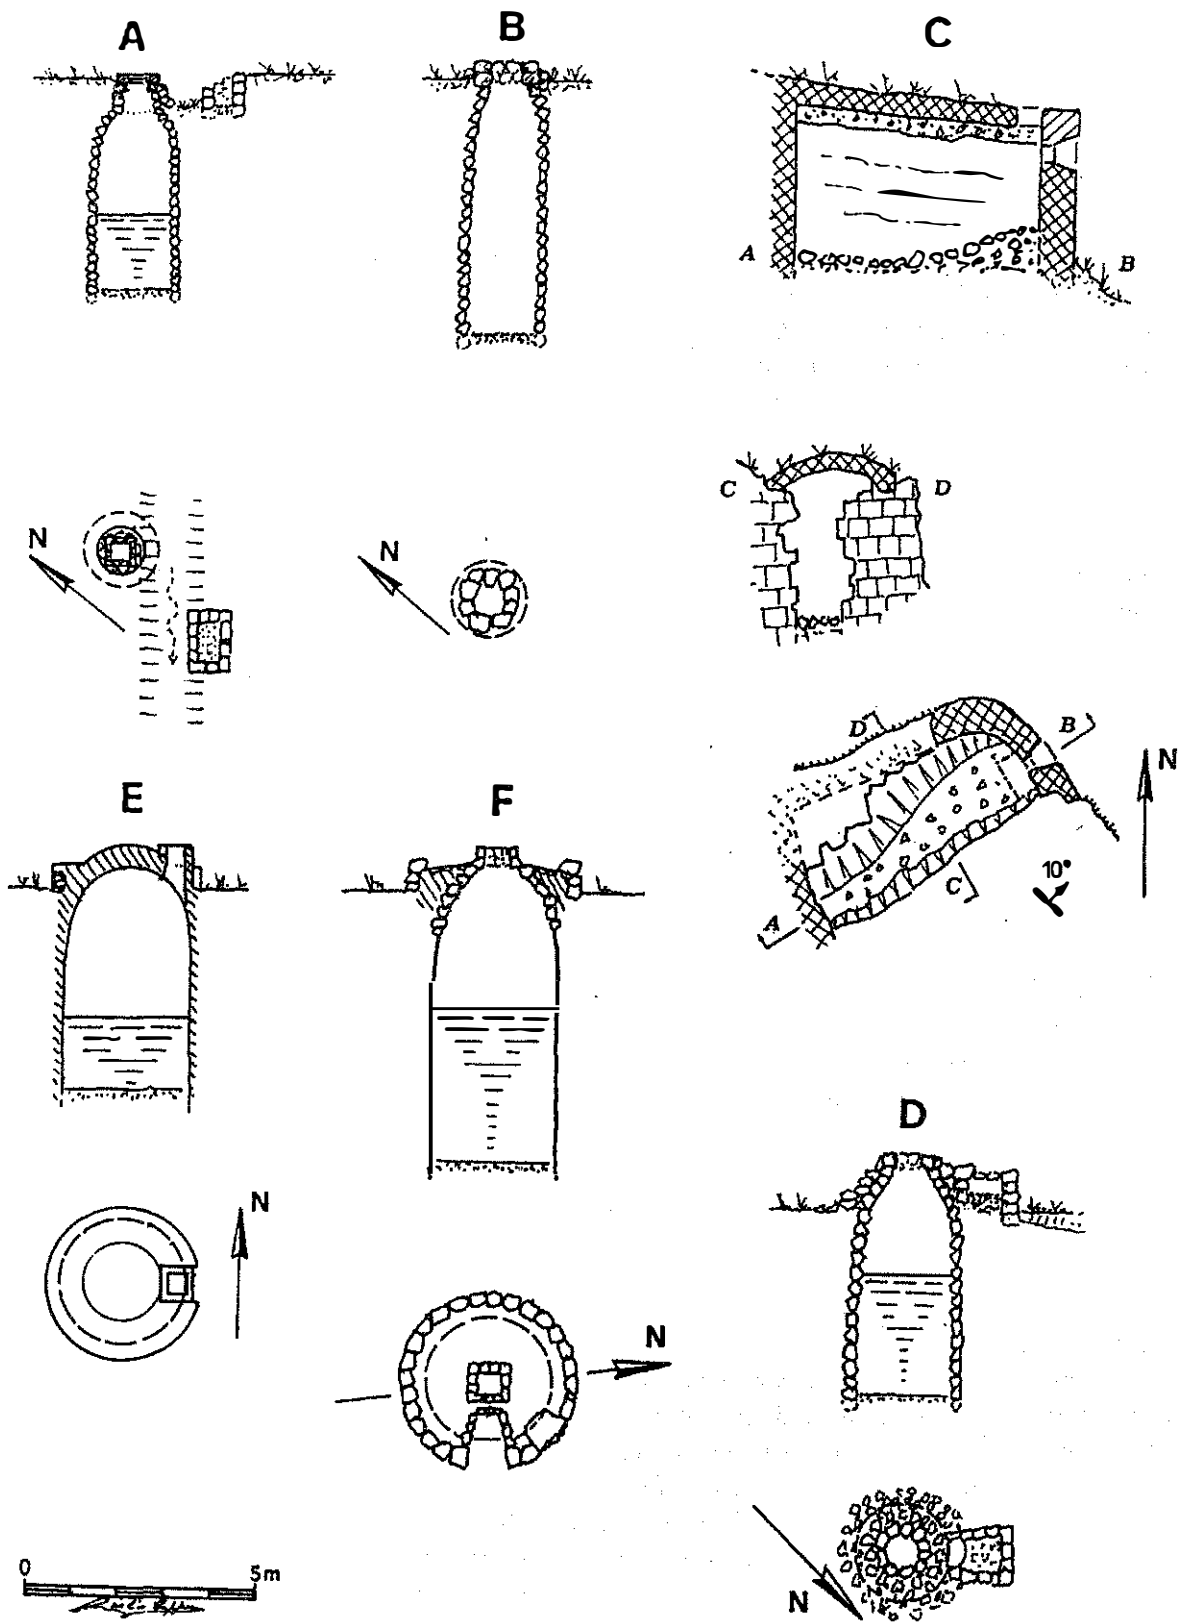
Pianta e sezione delle cisterne A, B, C, D, E, F di Fig. 2.
